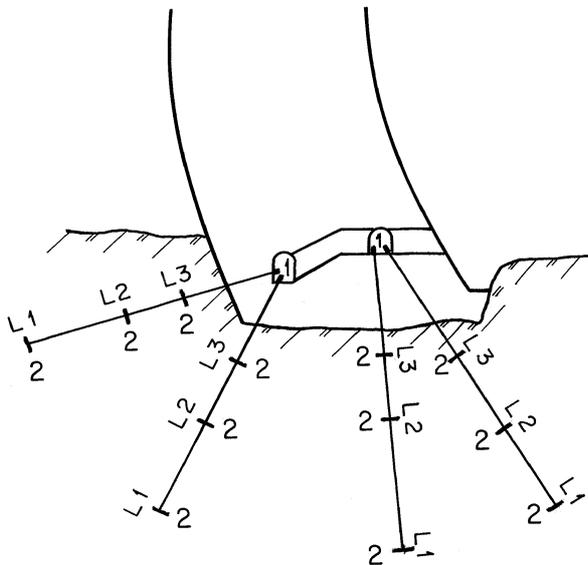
Disposition possible d'extensomètres dans la fondation d'un barrage en béton
